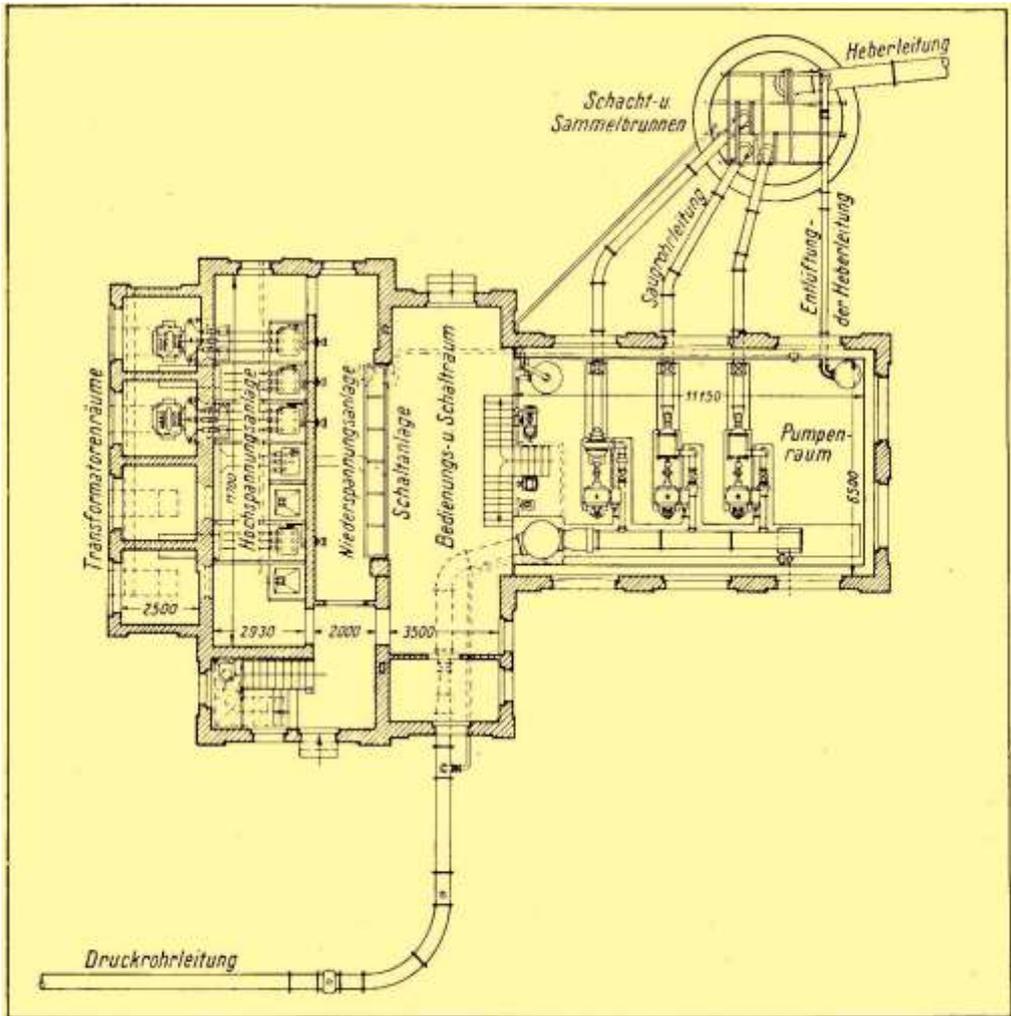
Das Wasserwerk Fortuna. Grundriß.
